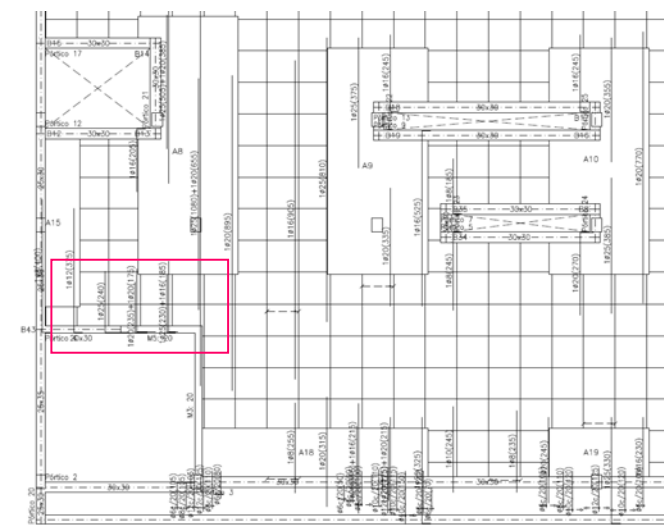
Armadura transversal superior necesaria previamente a la intervención
